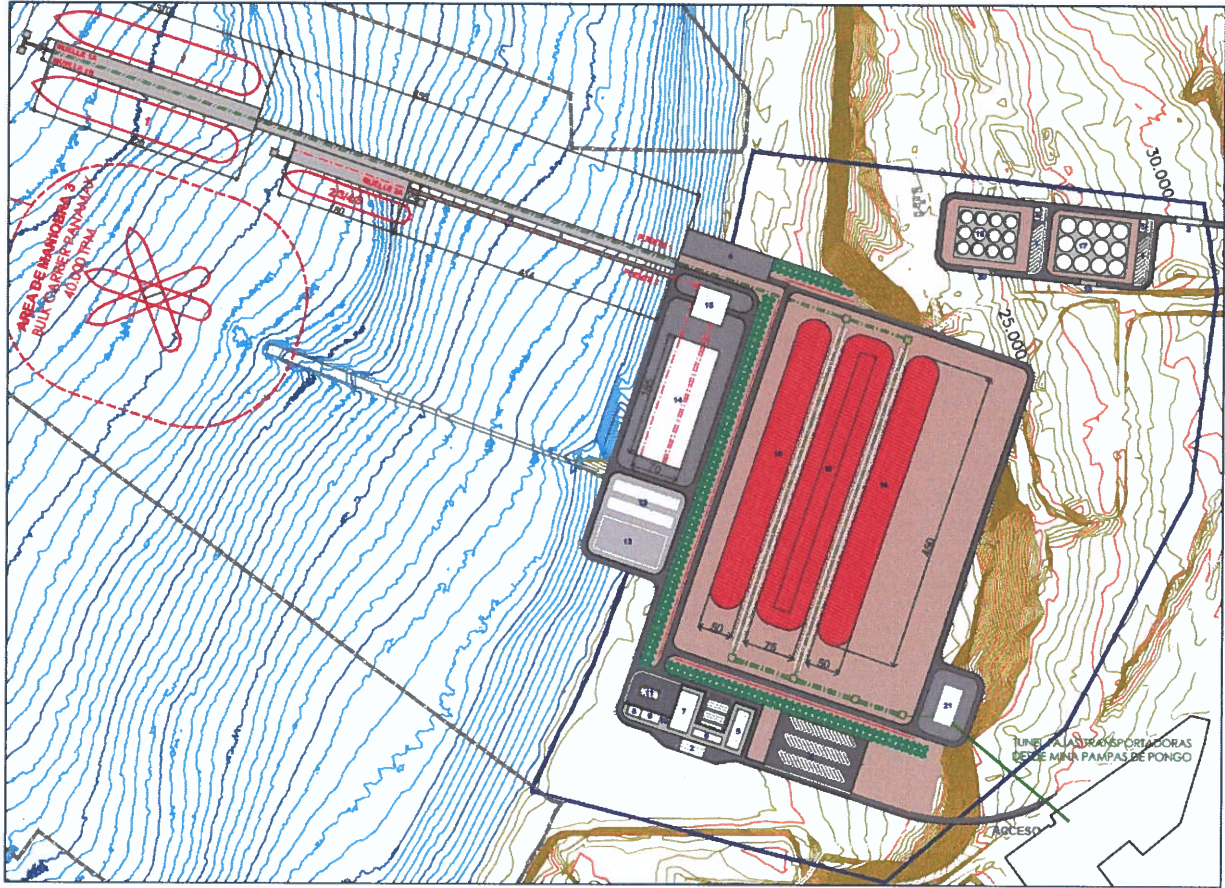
Layout Fase 2 – Escenario Moderado
